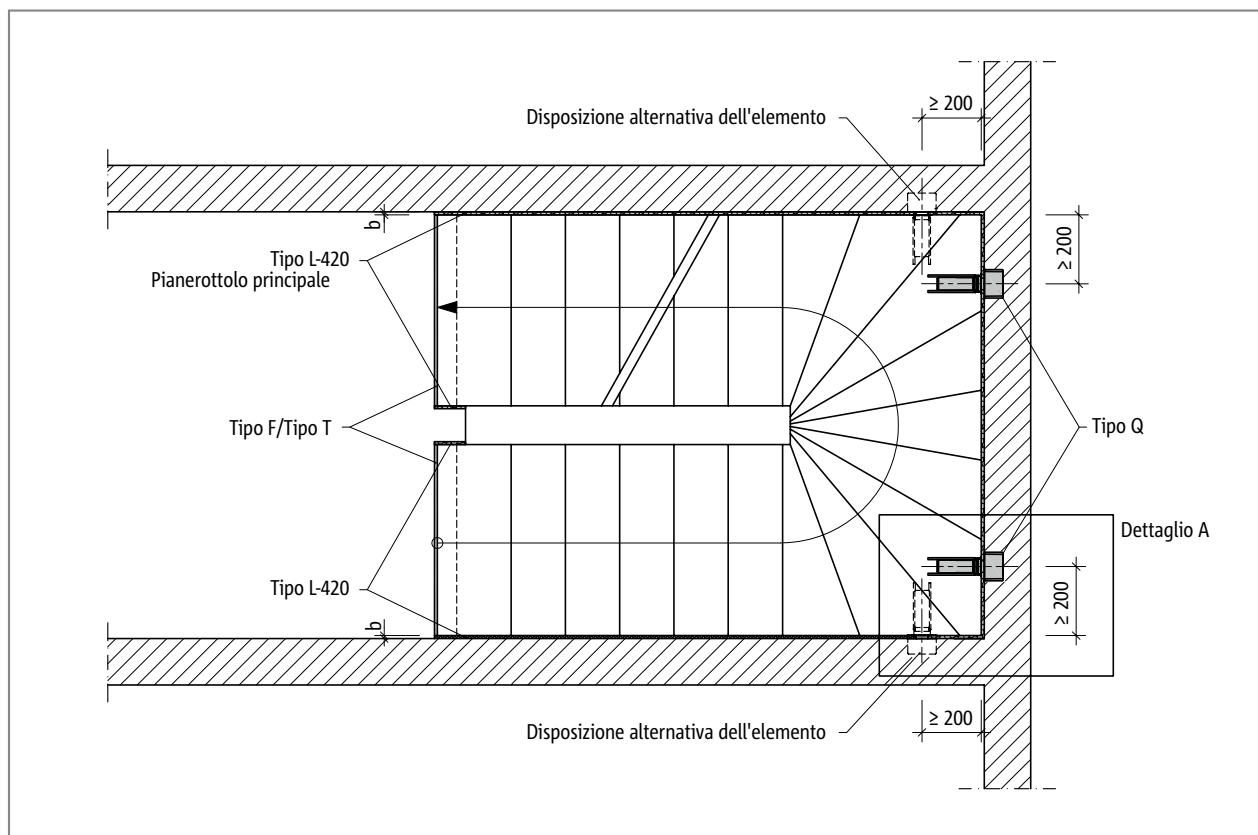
Schöck Tronsole® tipo Q, disposizione dell'elemento nella pianta mediante Tronsole® tipo L
